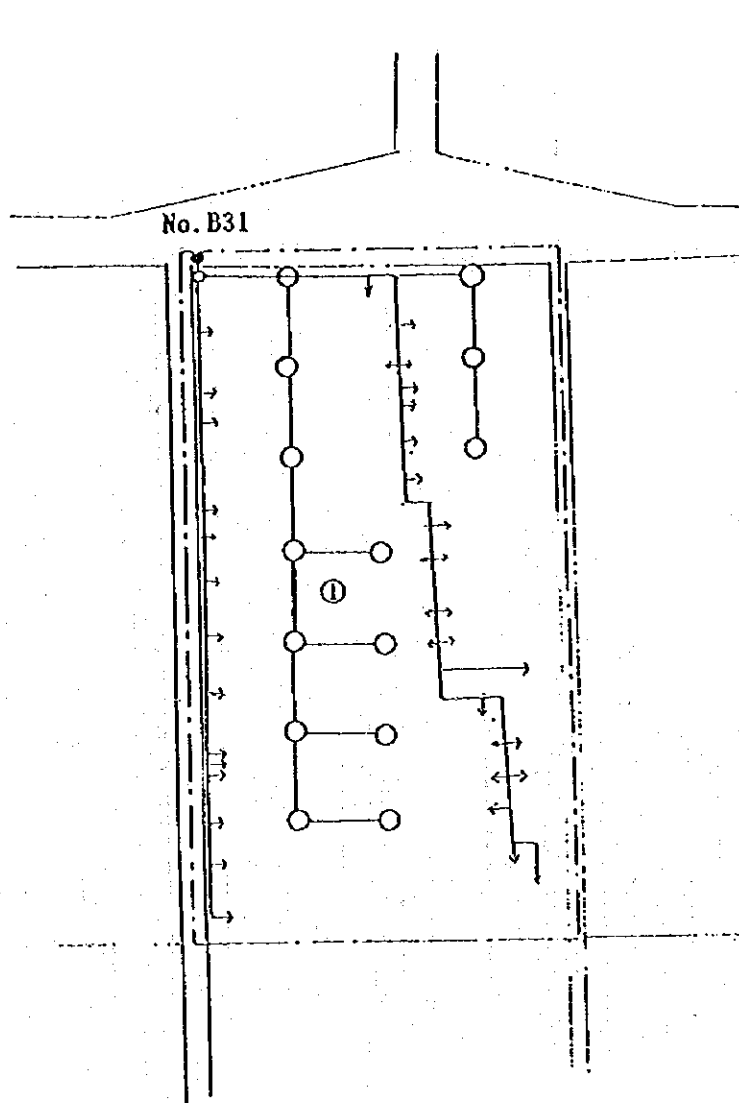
Plan horizontal du projet des installations terminales (Kasuba)
